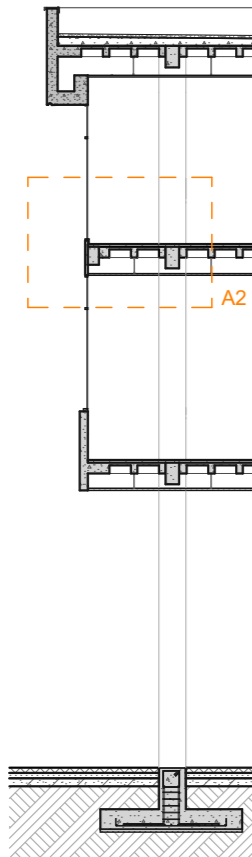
Detalle constructivo A1 || Fuente: Elaboración propia
